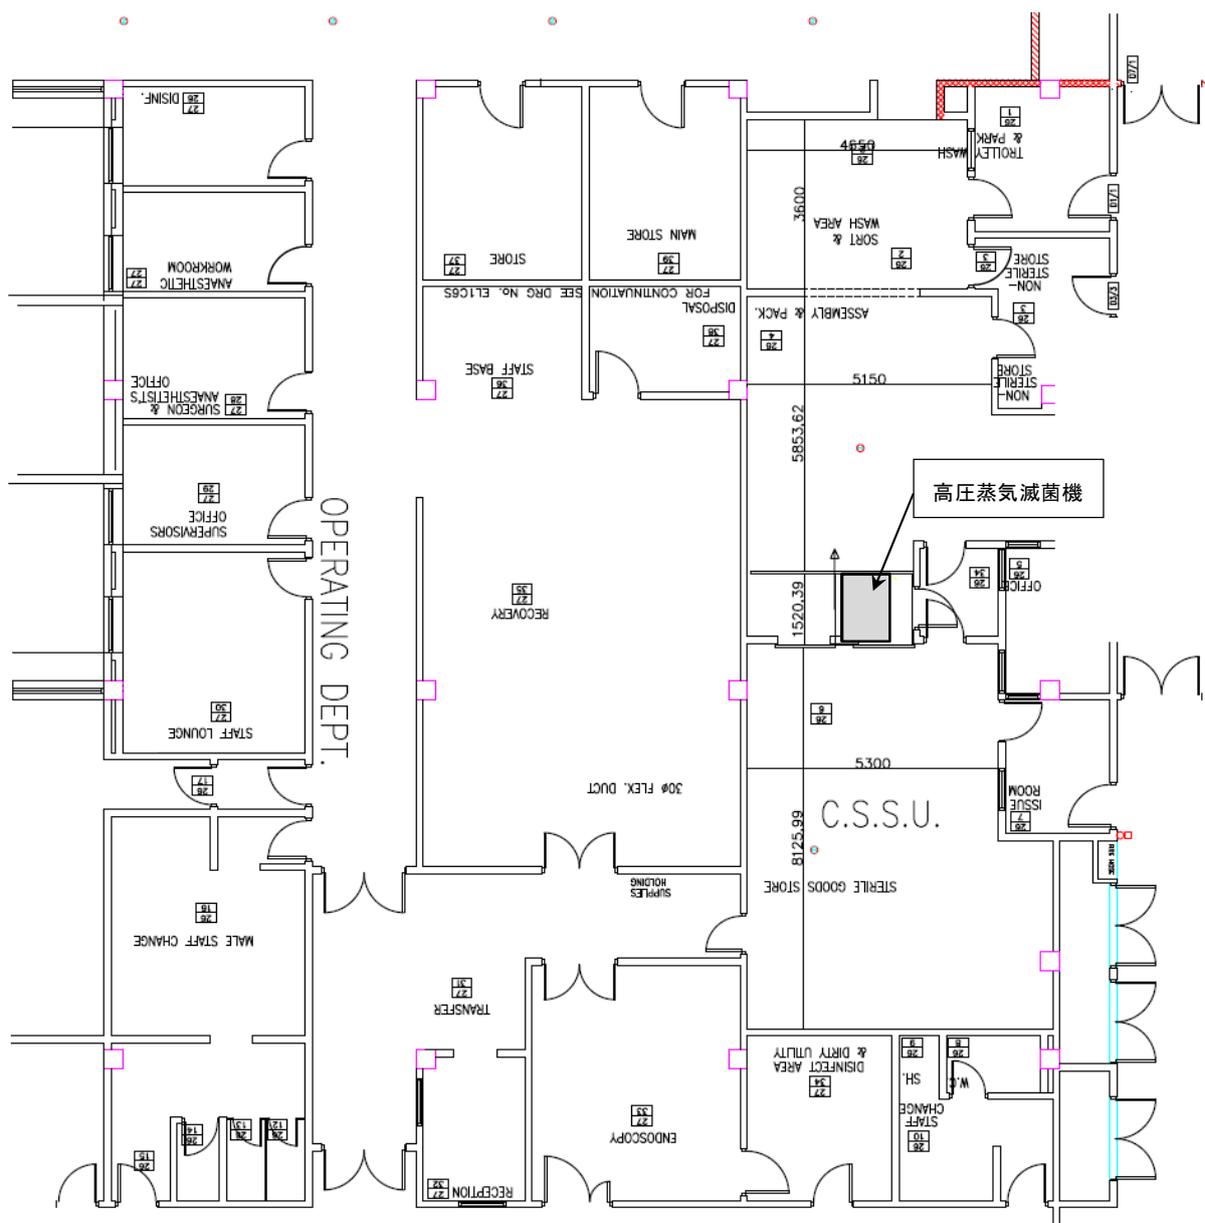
平面图・機材配置图 (高压蒸汽灭菌机、救急棟 2 階)
